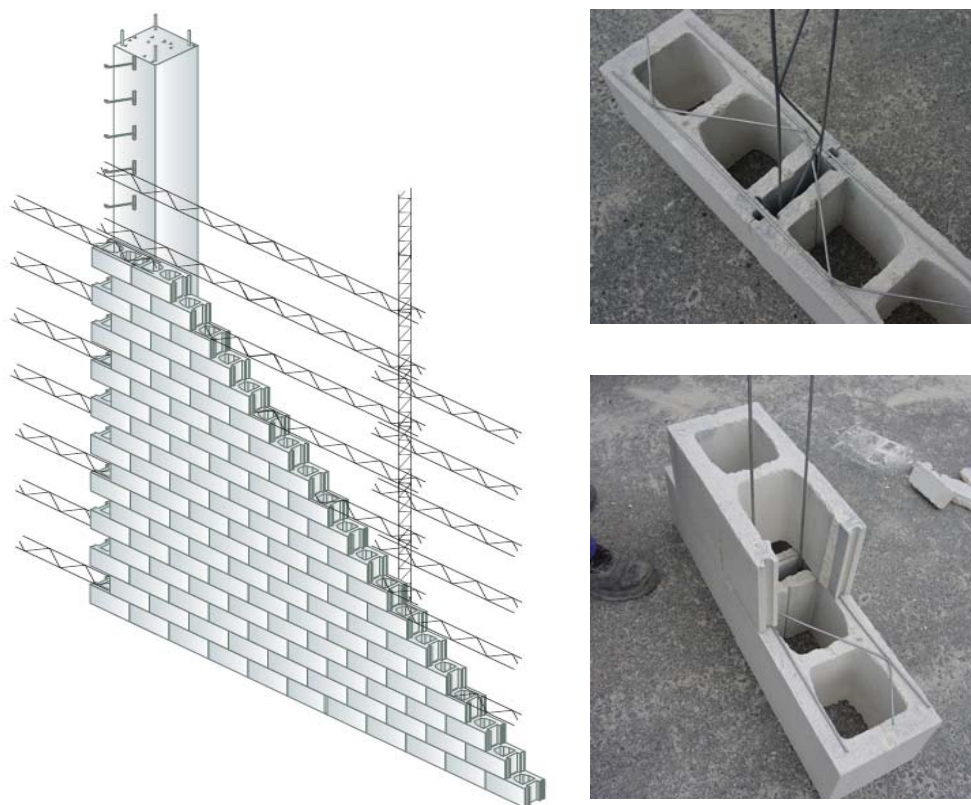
Sistema de armado en un muro acostillado. Uso de piezas especiales Bloc+.
